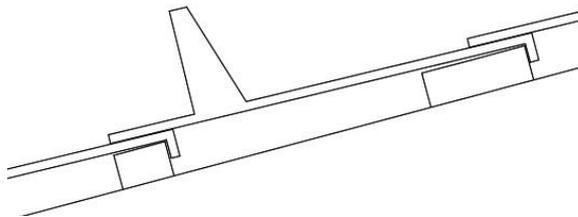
Verstärkte Ausführung mit Brett (oben)
